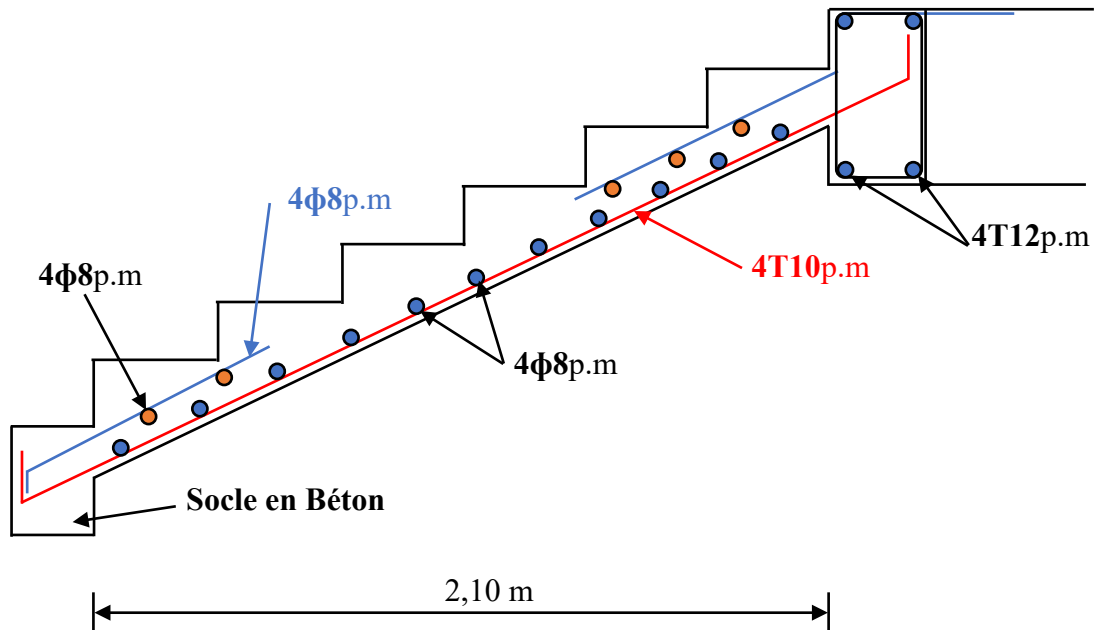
Ferrailage de l'escalier droit à paillasse
